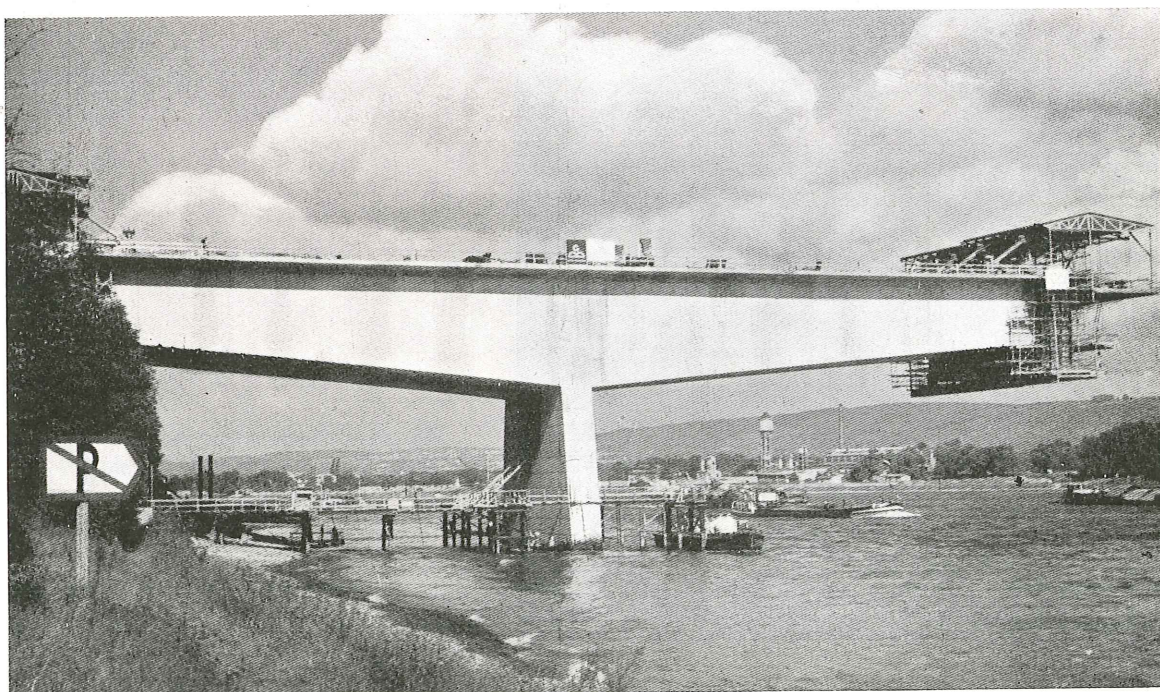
El puente de Bendorf comparte el tramo principal ya construido.
